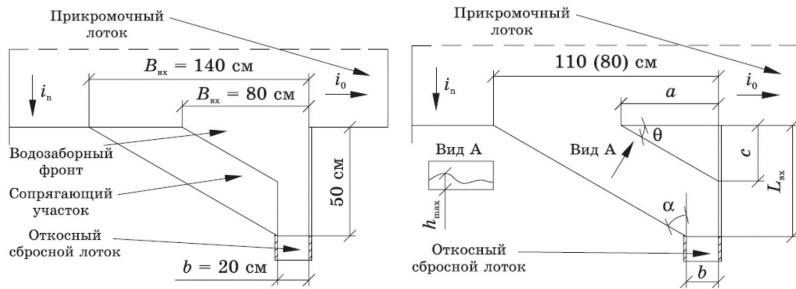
Традиционный вид входного участка сбросного лотка (слева); разработанная конструкция с острым углом (справа) [13]
